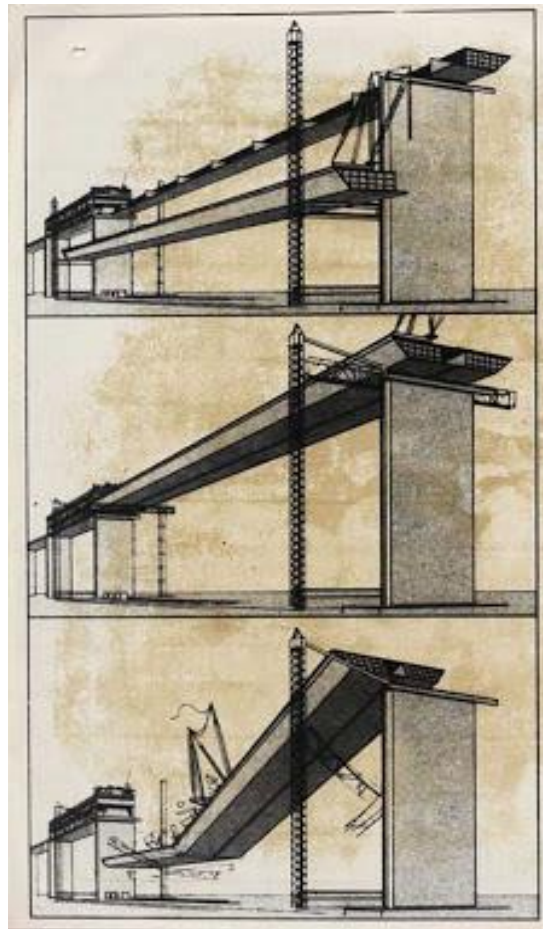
Colapso da West Gate Bridge (www.engineersjournal.ie)
